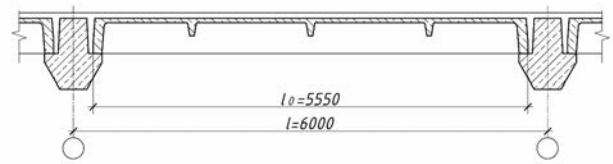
Розрахунковий прогін збірної залізобетонної плити перекриття
